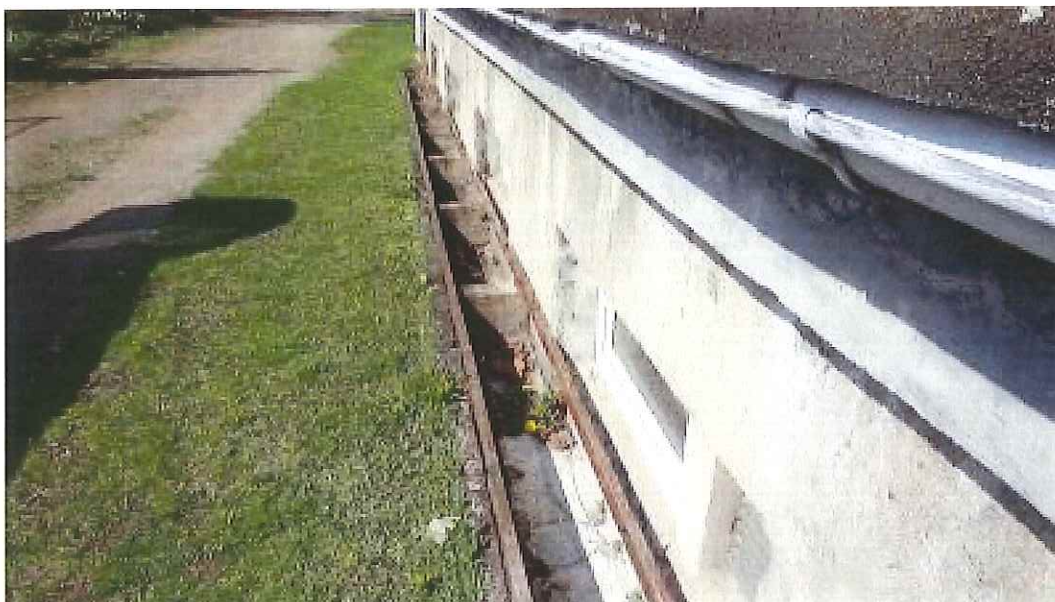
Klatka schodowa elewacja zachodnia. Widoczne zacieki na tynku poniżej nieszczelnych obróbek blacharskich. Tynk gruby cem-wap. miejscowo odspojony. Przy budynku opaska betonowa.
